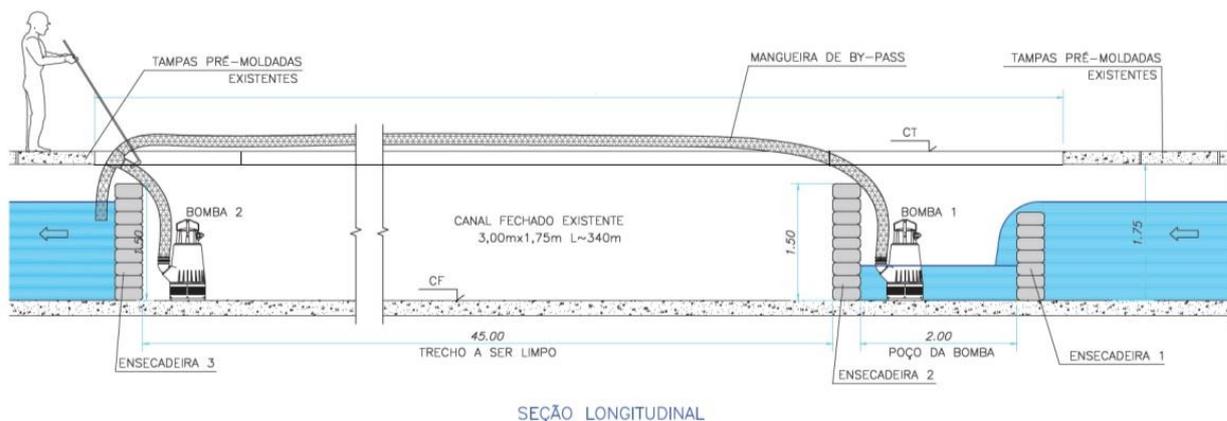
Seção Longitudinal Tipo para execução da limpeza da galeria
